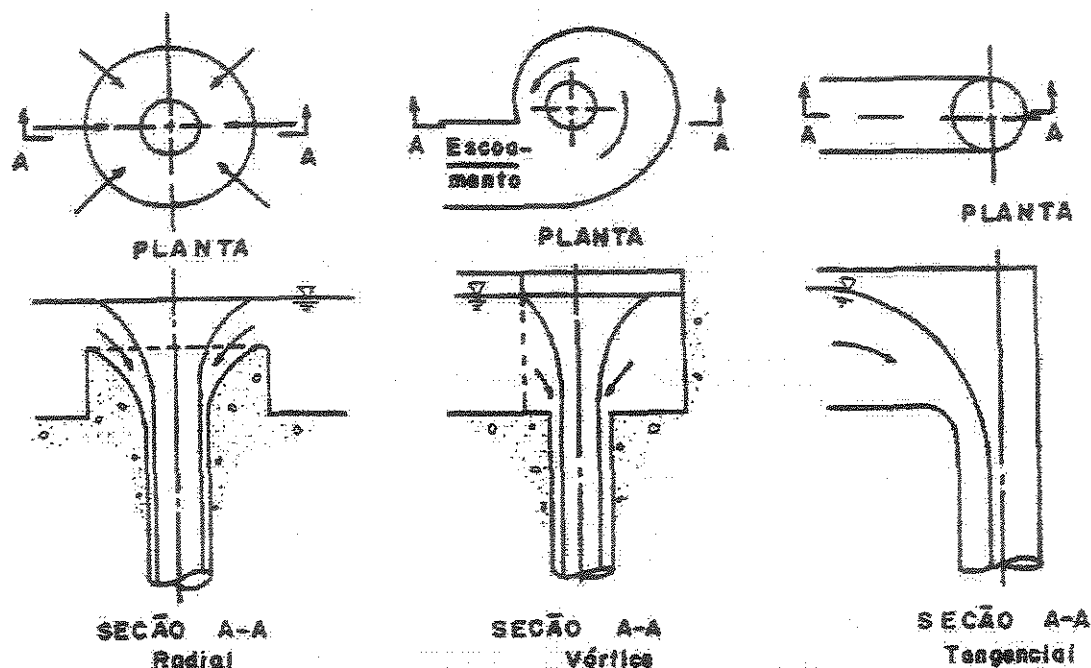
Tipos de entrada para poços verticais, segundo FALVEY (1980)
